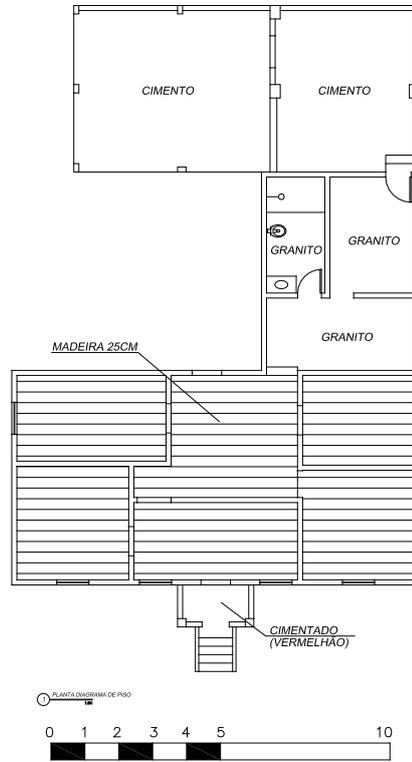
Planta pavimento térreo - Casa Armando Porcari
